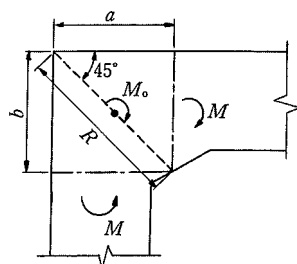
III-97 節点部の応力照査をする断面(ハンチがある場合)
